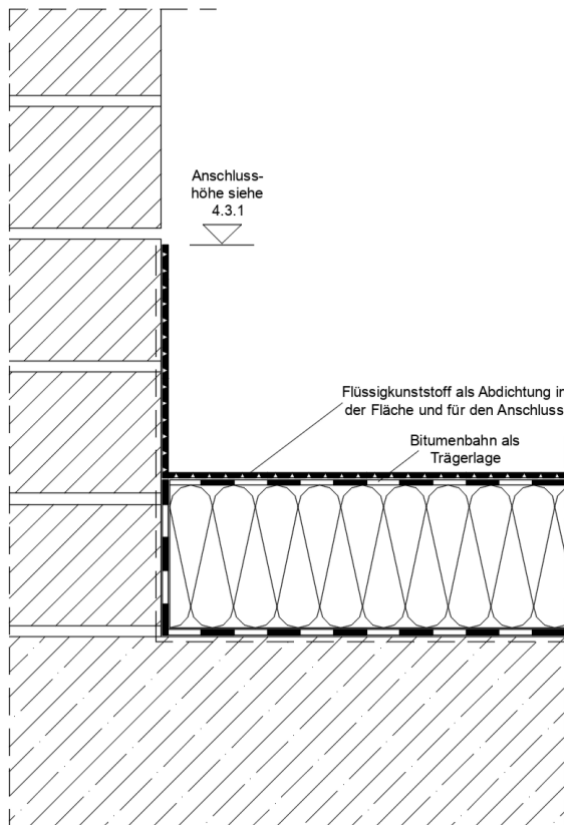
Starrer Wandanschluss mit Flüssigkunststoff – ungedämmte Wand (Abdichtung in der Fläche mit Bitumenbahnen)
